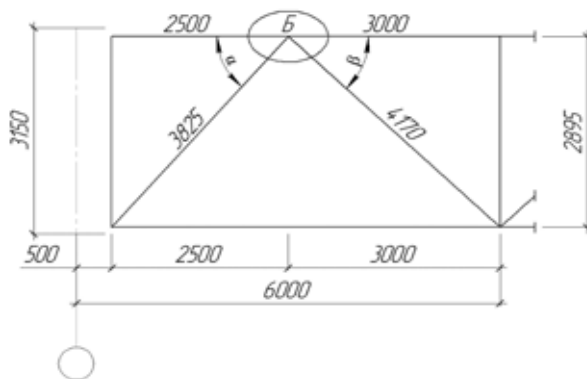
Геометрическая схема фрагмента опорной части фермы
